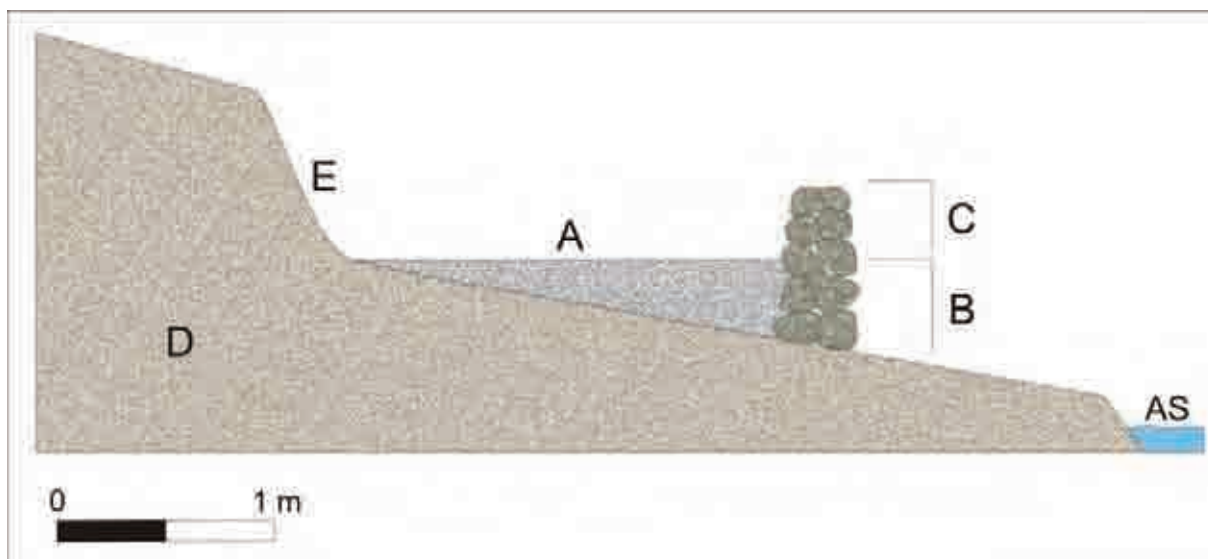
Esquema general de disposición de los elementos mencionados: A= superficie del camino y relleno (ancho: 2 m); B= muro de contención ladera abajo; C= muro de protección ladera abajo; D= ladera del cerro; E= sector ladera arriba excavado; AS= cauce del arroyo Simbolar.
